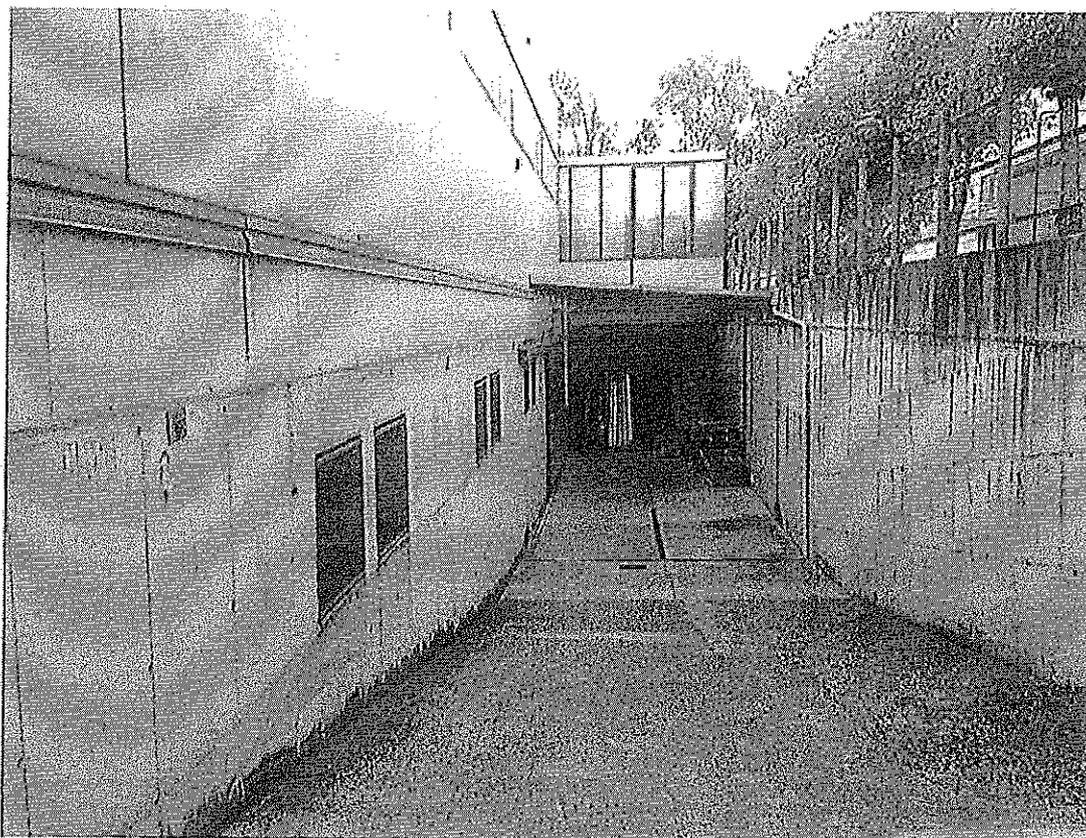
Rampa per l'accesso al piano interrato del fabbricato in via Quarenza.
